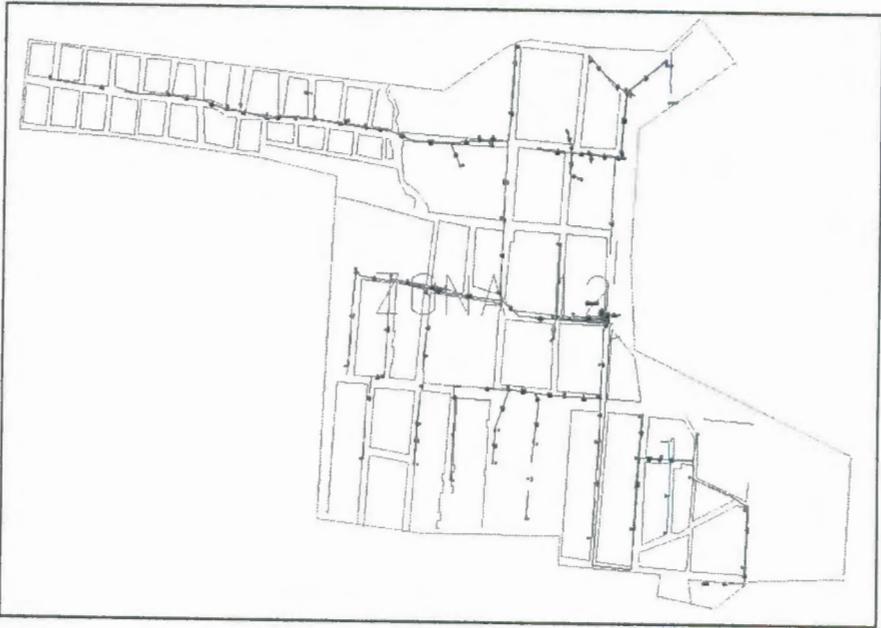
Planimetría zona 12 del sector de la vía a Daule
